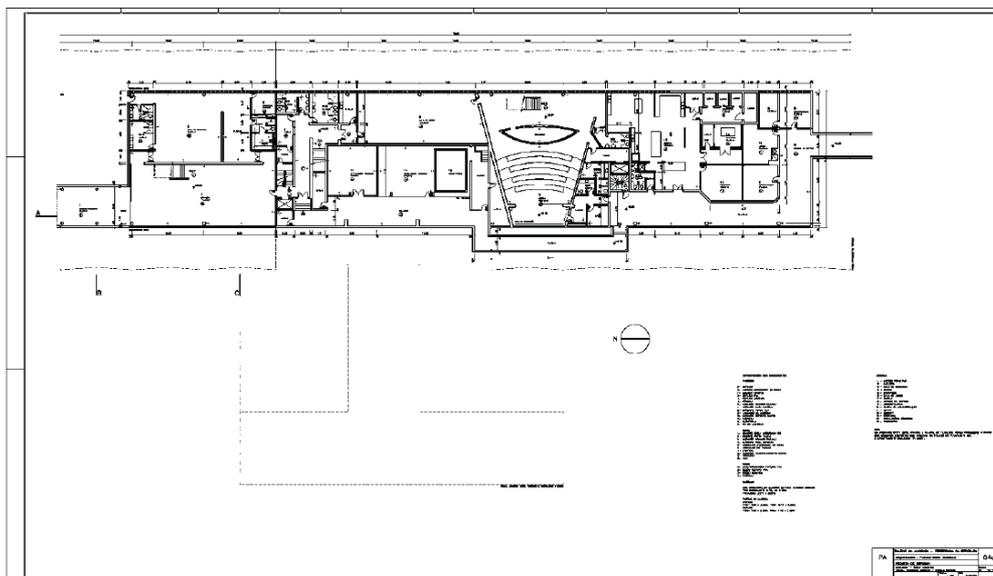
Planta Baixa Original - Subsolo do Palácio da Alvorada.
